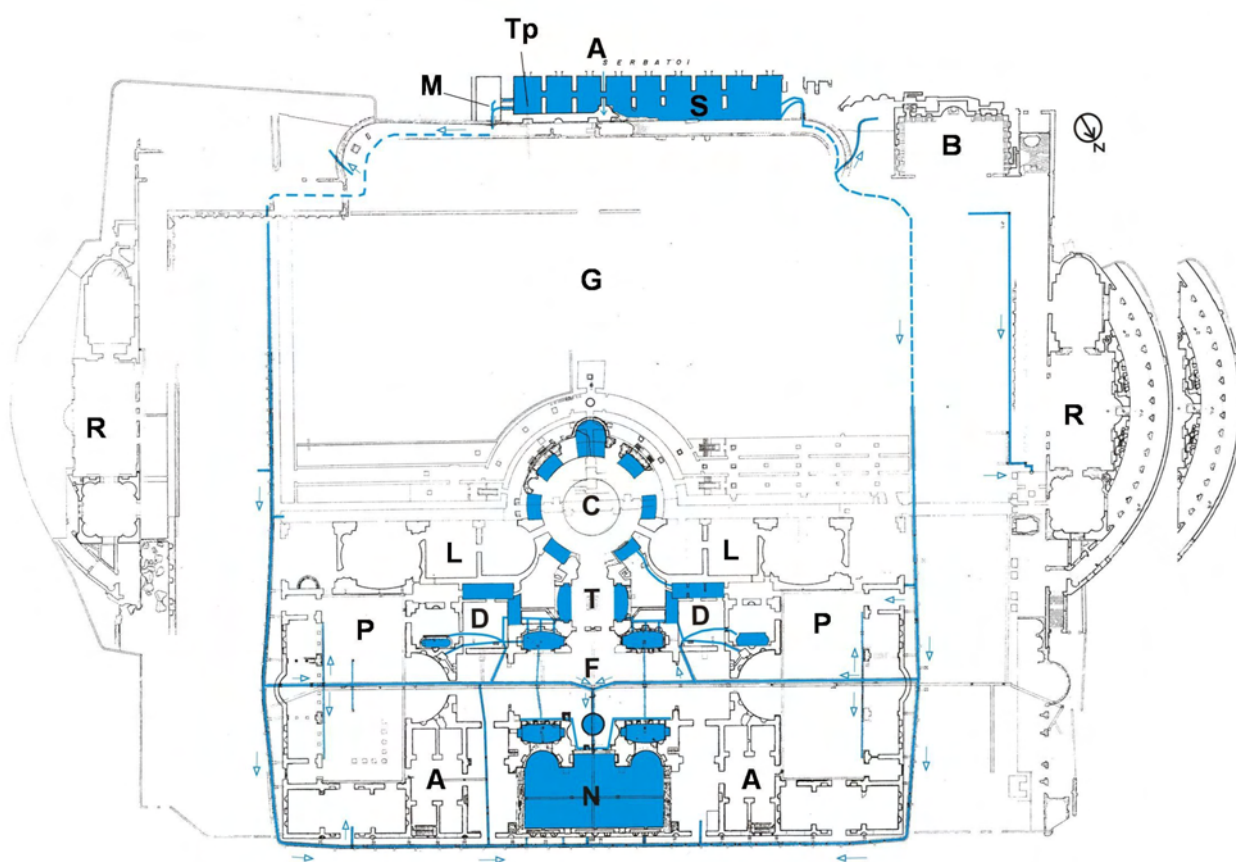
Planimetria delle Terme di Caracalla con schema dell'impianto idraulico di adduzione e distribuzione dell'acqua. (da CORAZZA & LOMBARDI, 1995).
